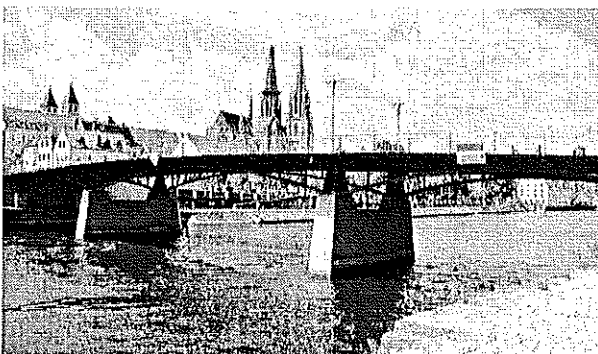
Autre exemple de pont utilisant un acier S690 : Eiserne Brücke à Regensburg
